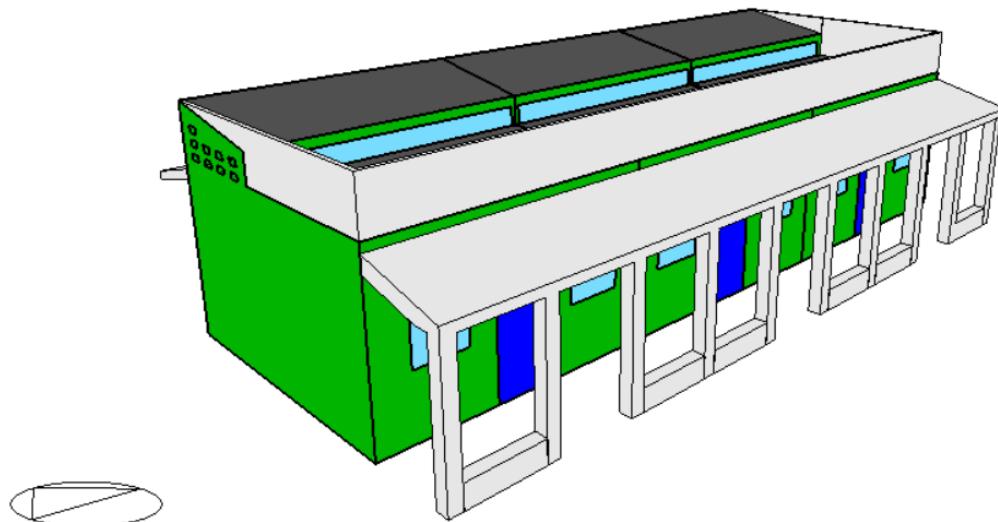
Modelo Tridimensional del Módulo de Aulas – Vista Suroeste
